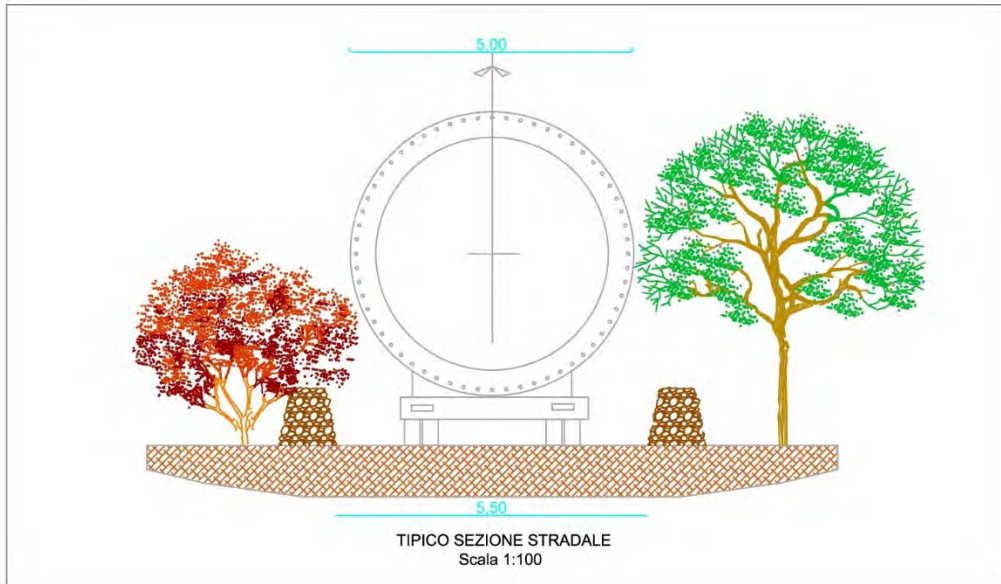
Tipico sezione trasversale strade di accesso al cantiere per trasporti eccezionali
